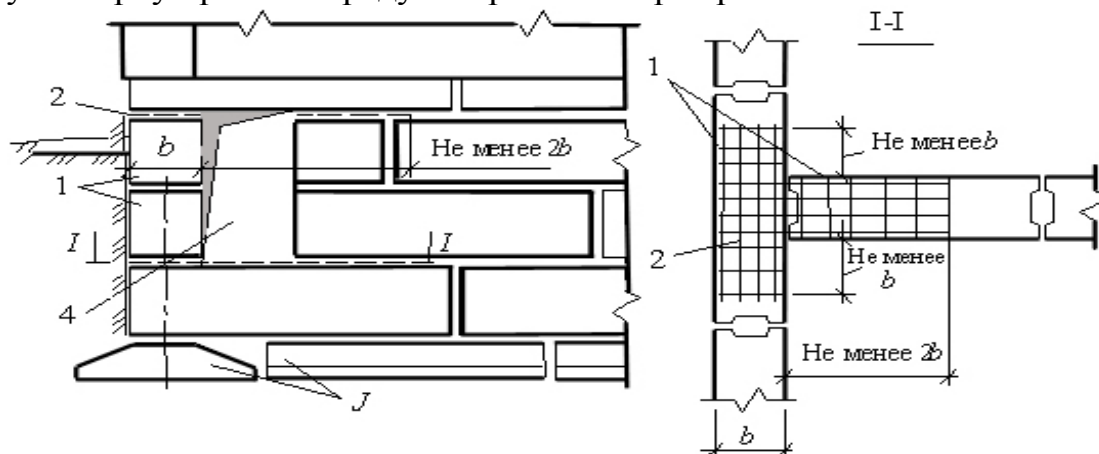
Устройство проемов в стенах подвала: 1 – блоки стен подвала; 2 – арматурные сетки из стержней $\varnothing 8$ мм; 3 – фундаментные плиты; 4 – проем в стене подвала
